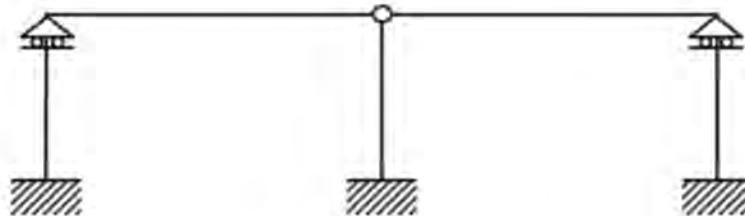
Strutture monopiano con pilastri secondari collegati con appoggi mobili
